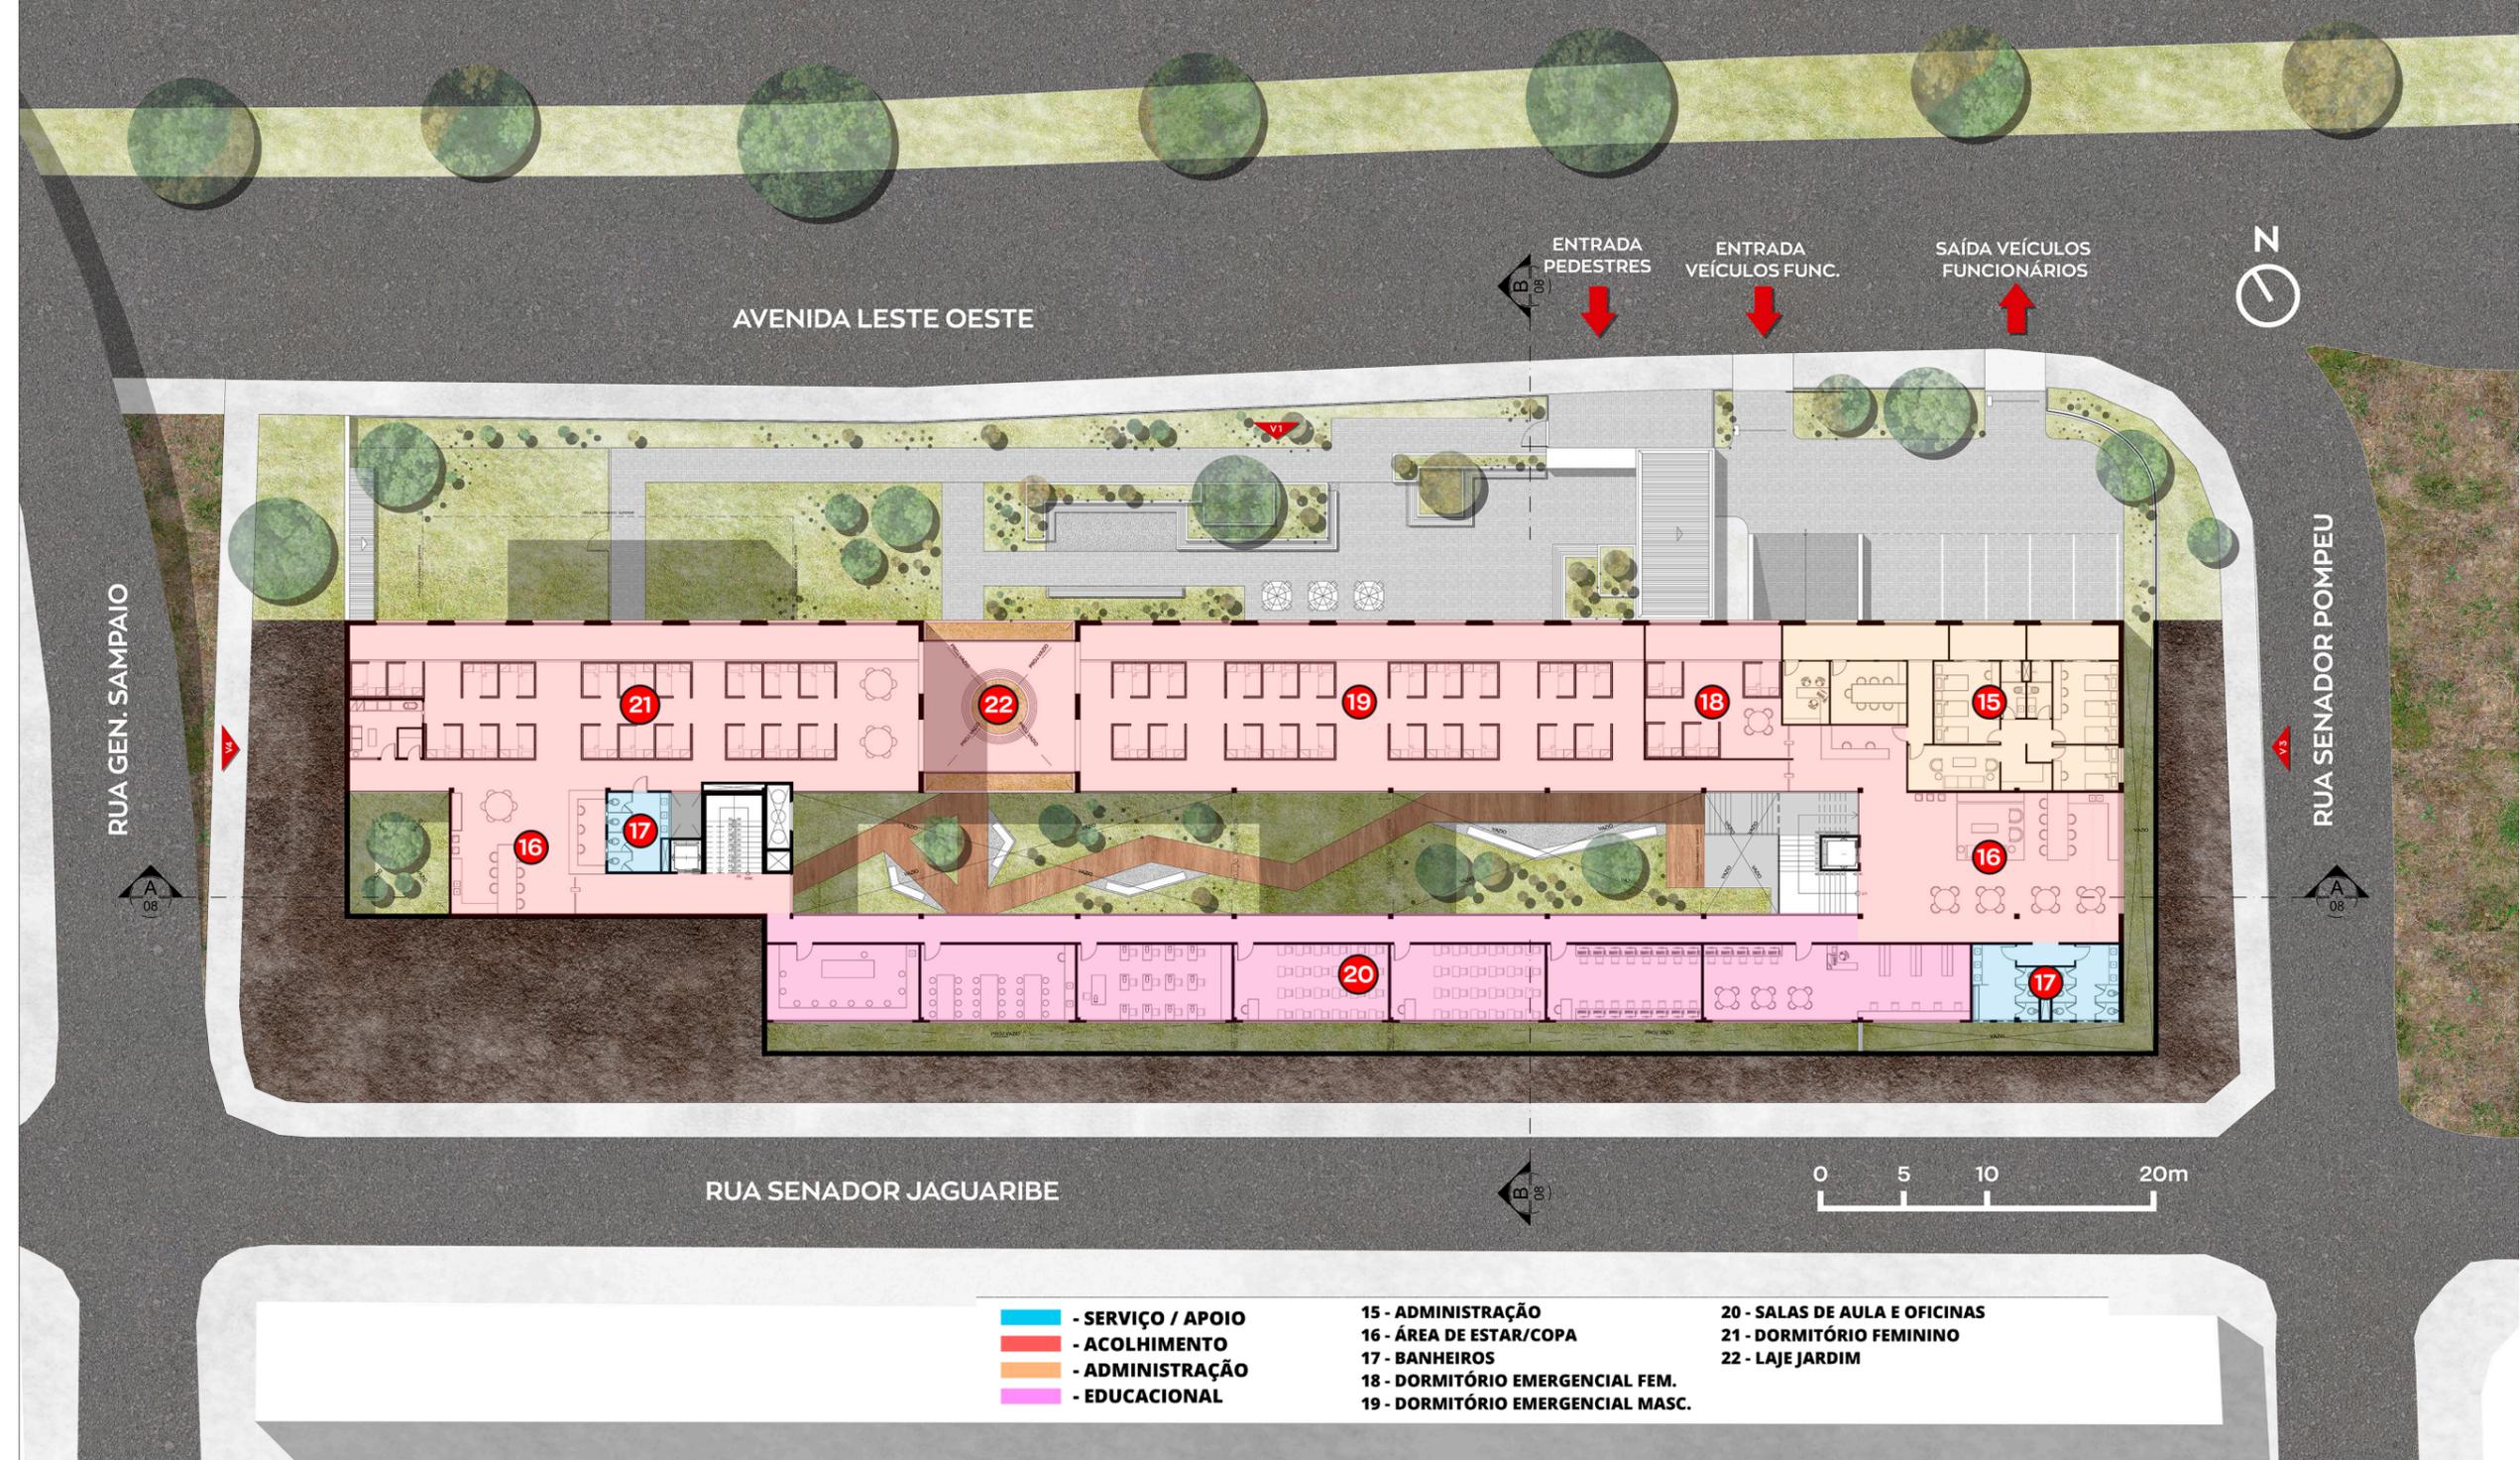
Planta baixa 1º Pavimento. Fonte: Autoral.
